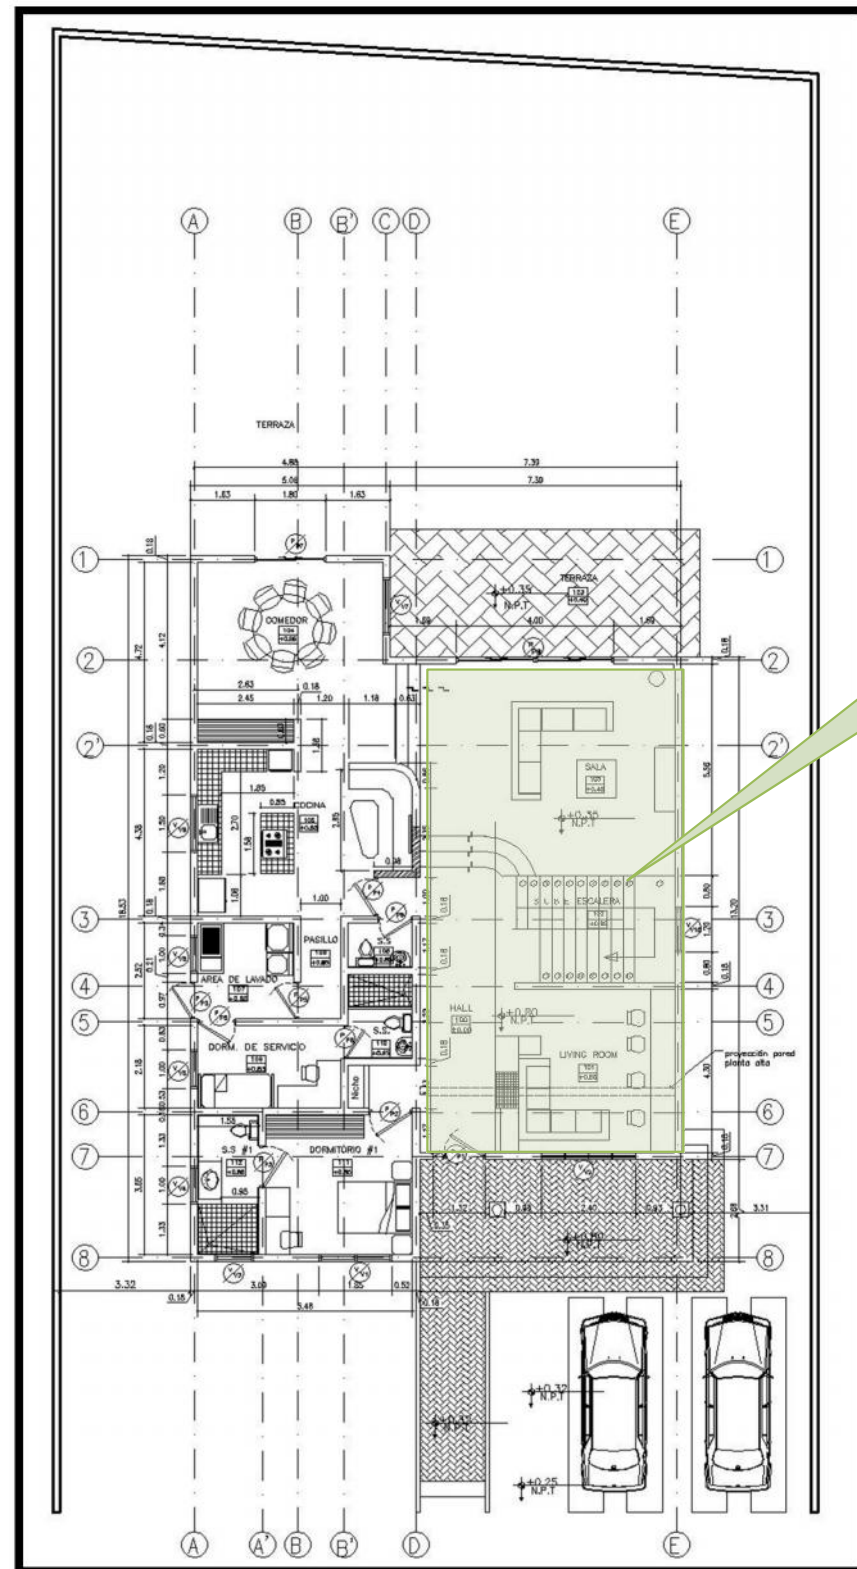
Planta Arquitectónica Baja Primer cambio, La Sebastiana
